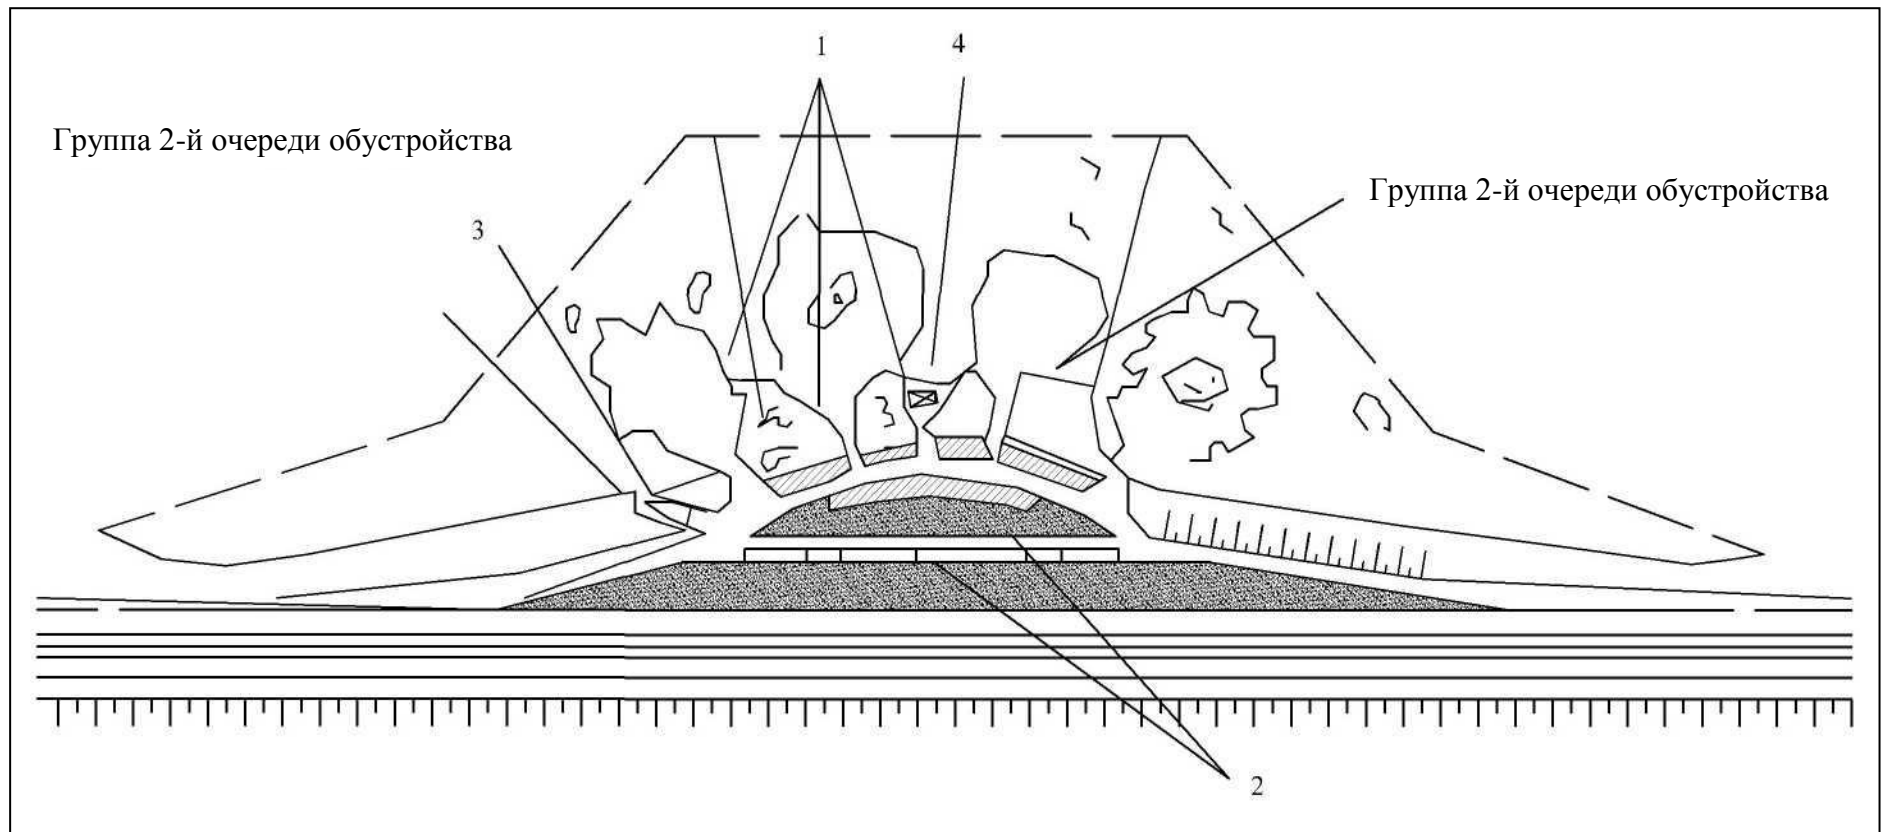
Пример (схема) площадки для стоянок на перегоне:
